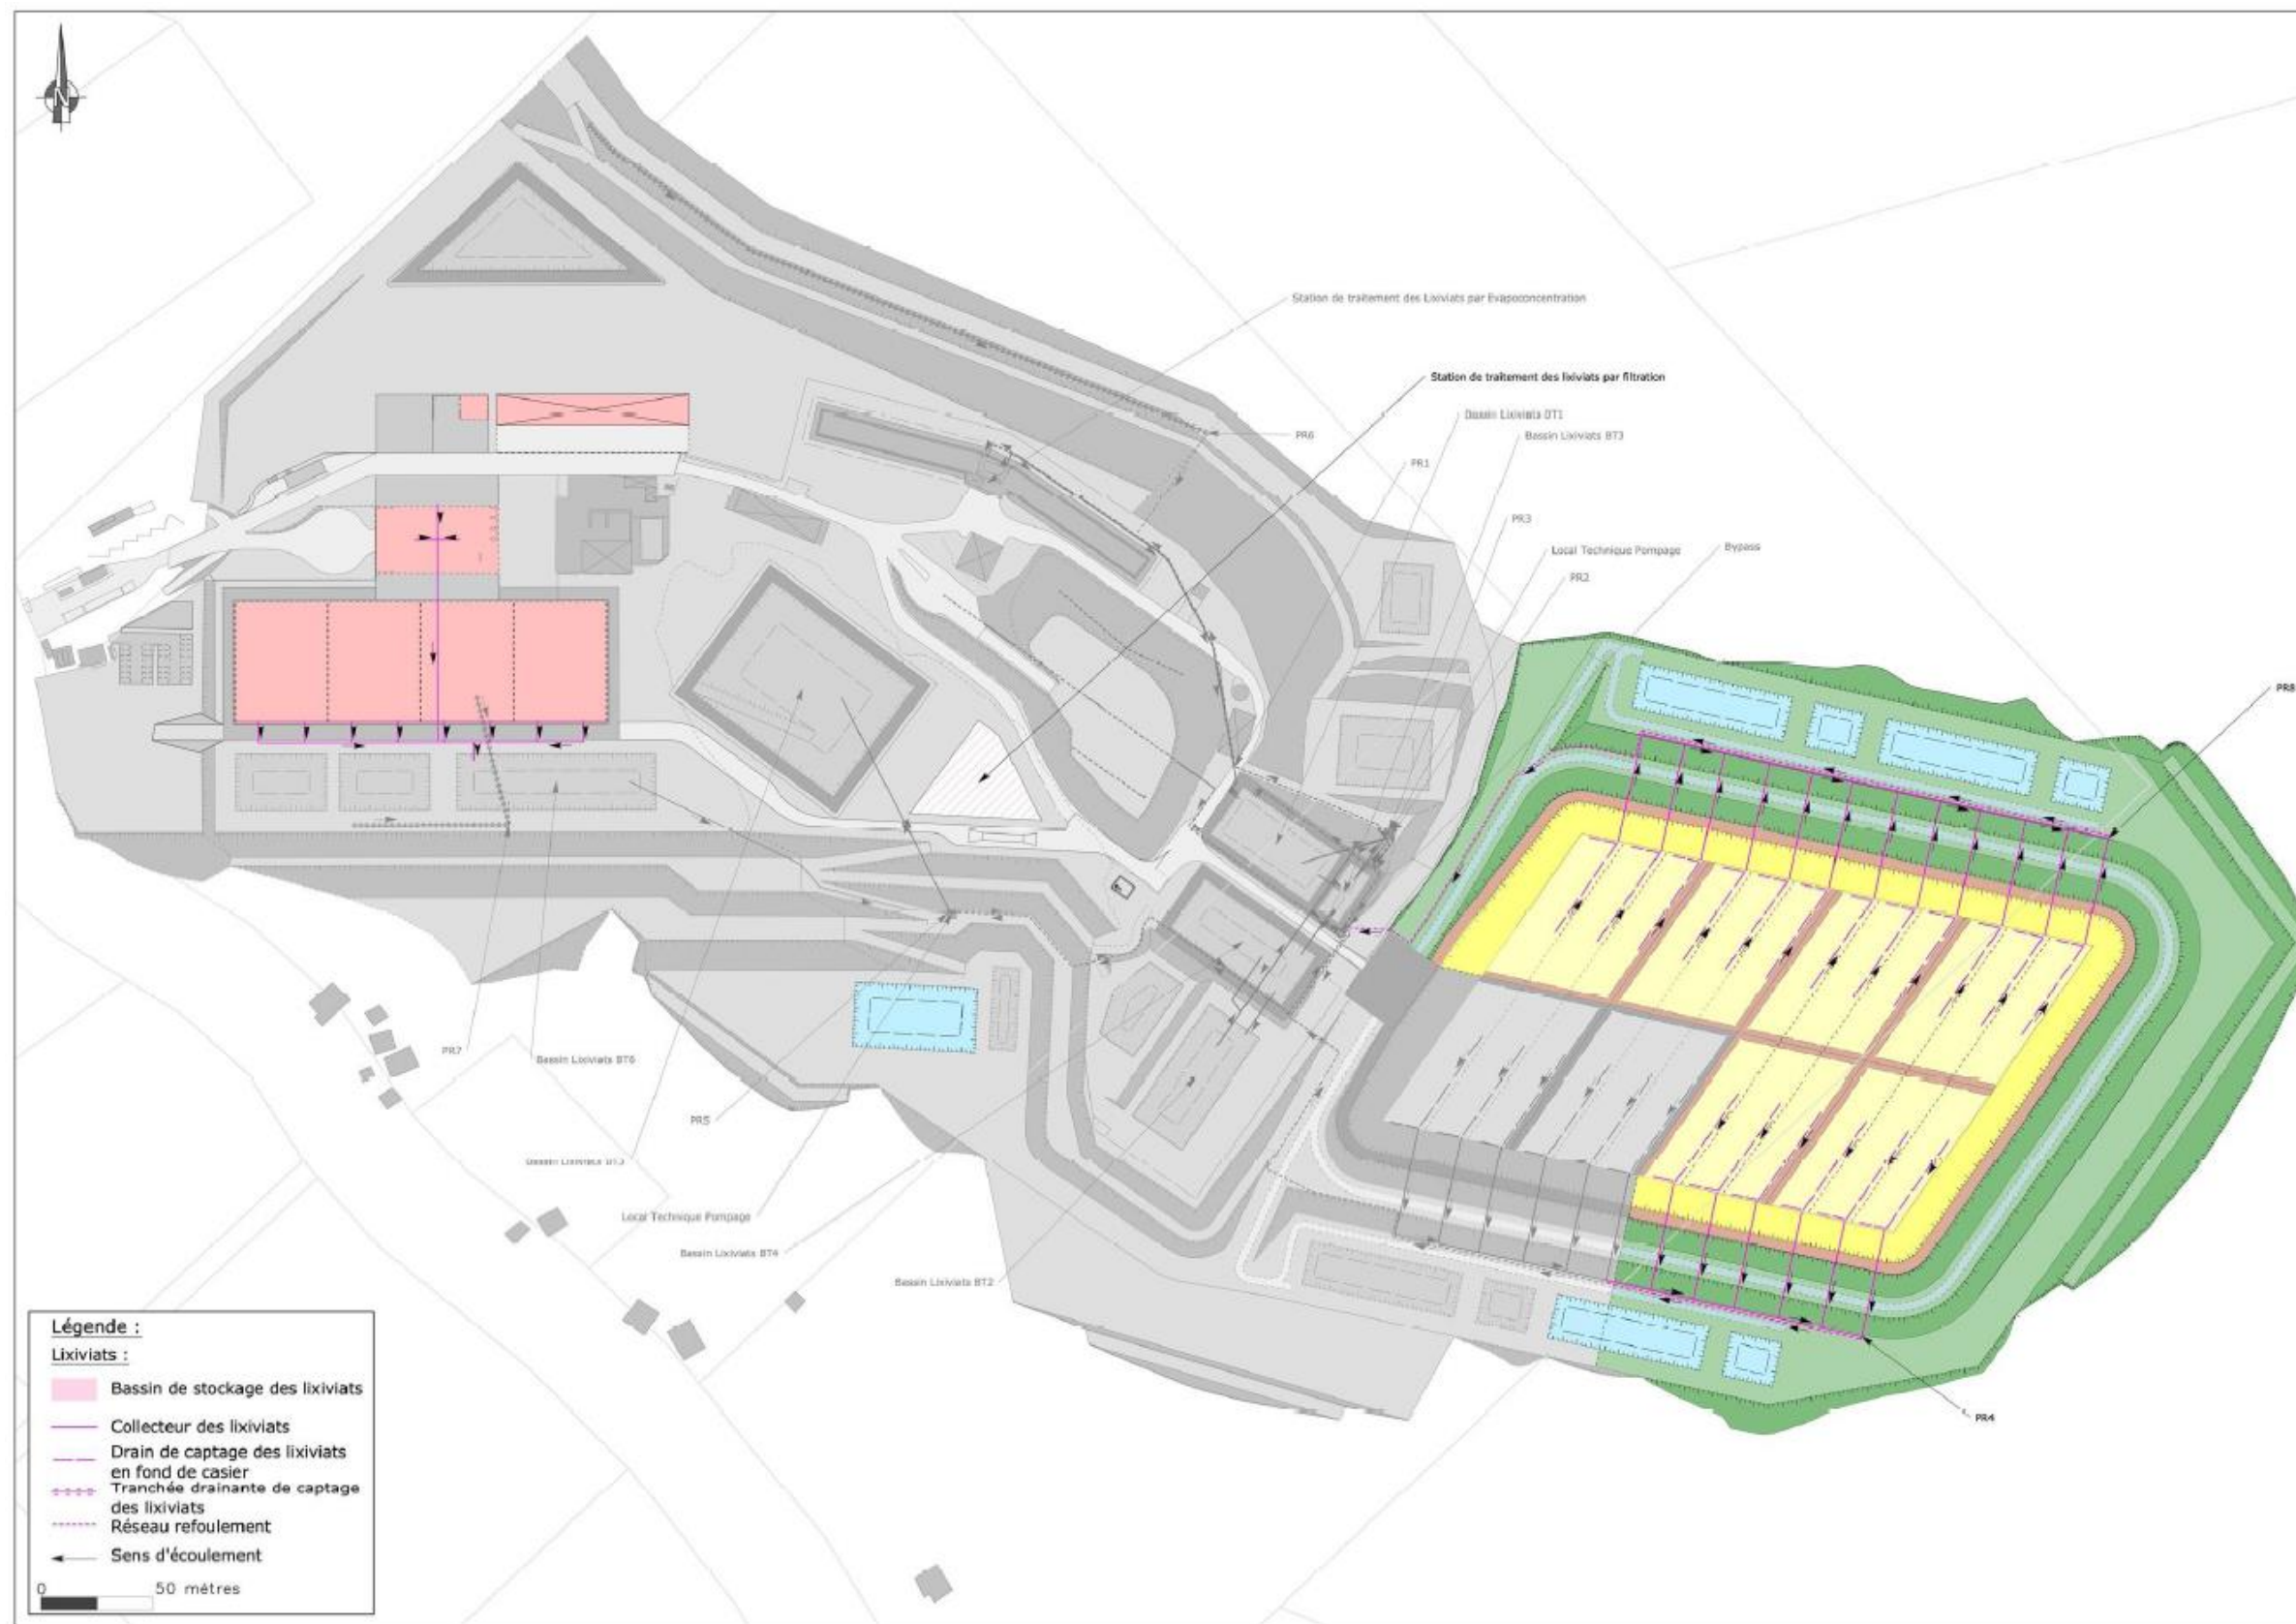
Plan du réseau de collecte des lixiviats niveau 1 (Source : BETA Environnement)
